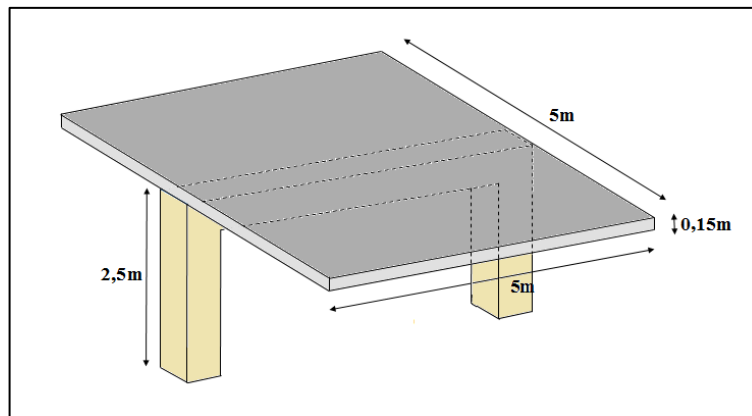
Dimensiones de la losa de hormigón para el cálculo del área tributaria de un piso.
